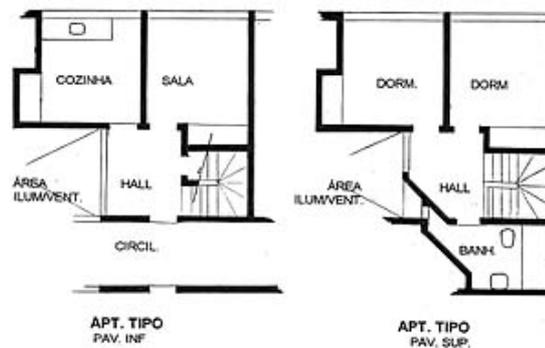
Edifício Japurá - Planta dos apartamentos-tipo
